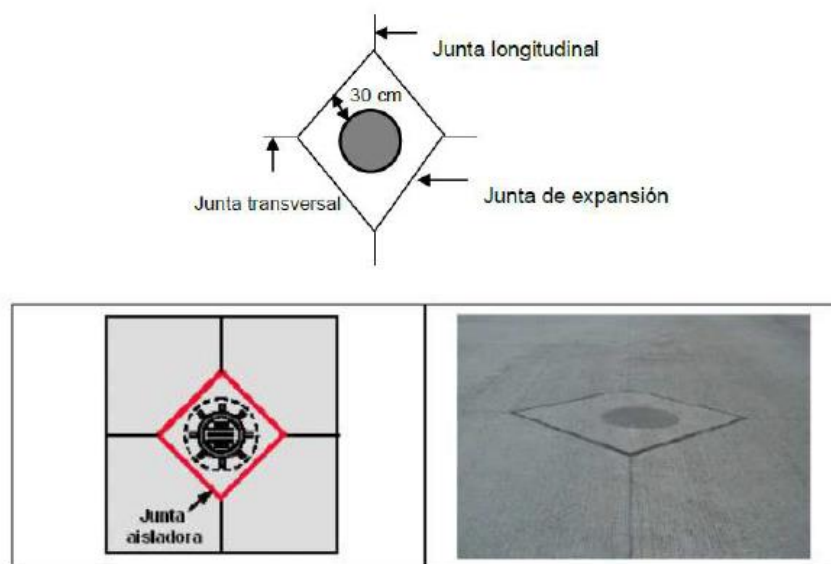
Detalle en Junta pozo de Inspección Rectangular
